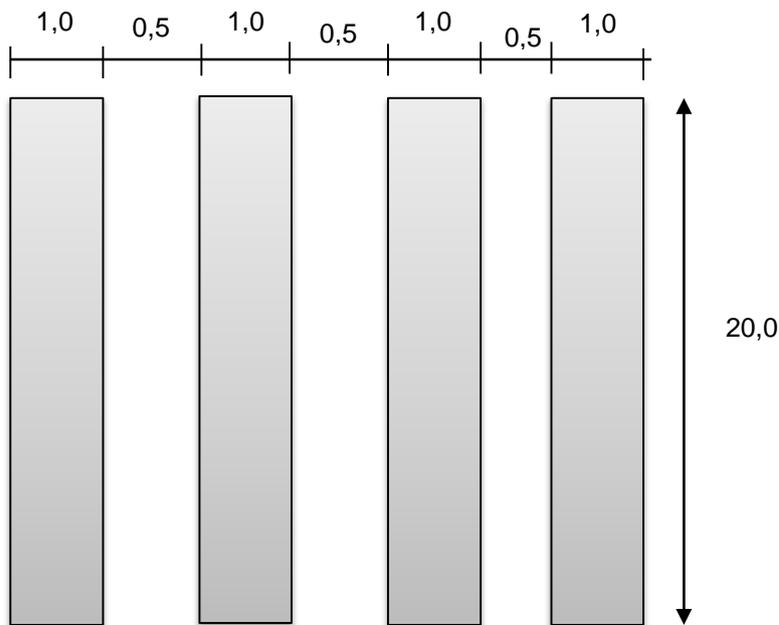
Vista de Planta de cama o cuna para producción de Humus
